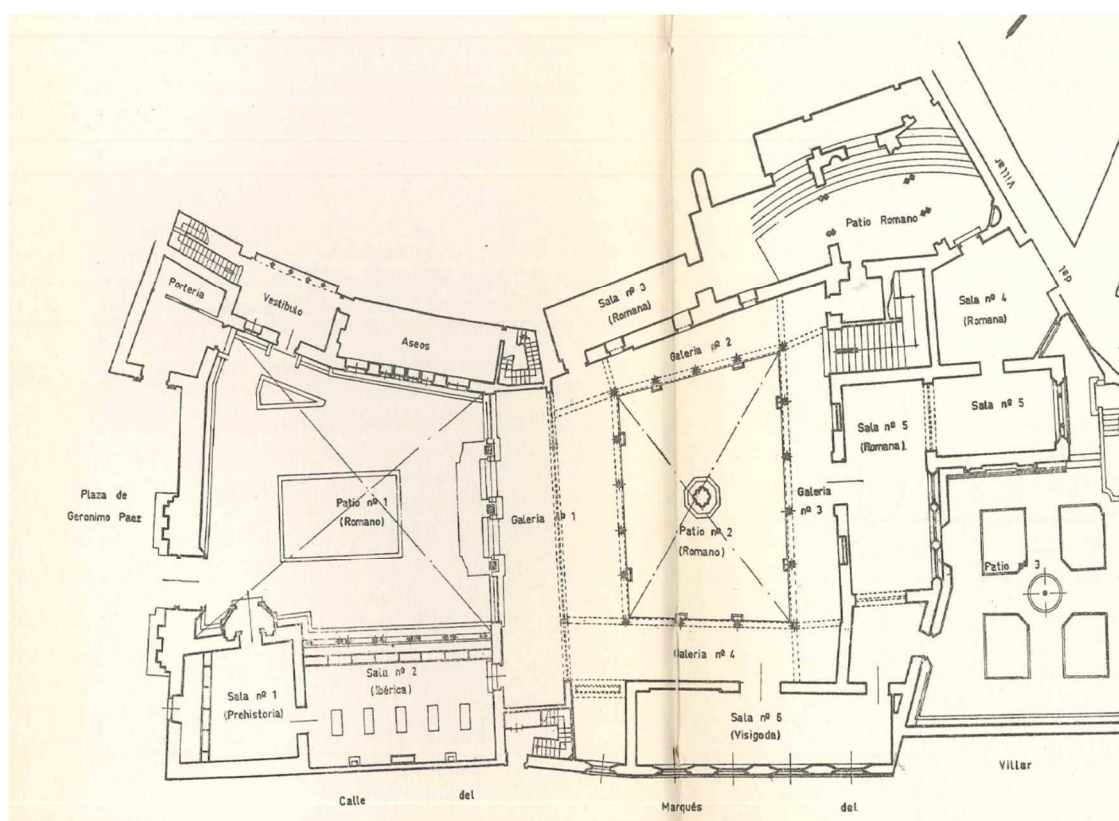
plano de la planta baja del Museo Arqueológico. Vicent, 1965, s/p.
